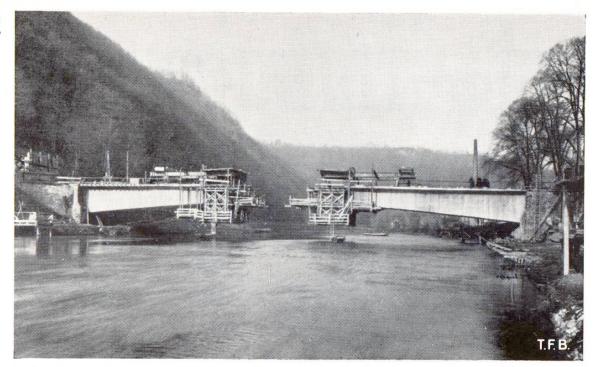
Pont sur la Lahn, Balduinstein. Construction en porte à faux des poutres maîtresses au moyen de coftrages mobiles (Photo Mais, Limburg)
